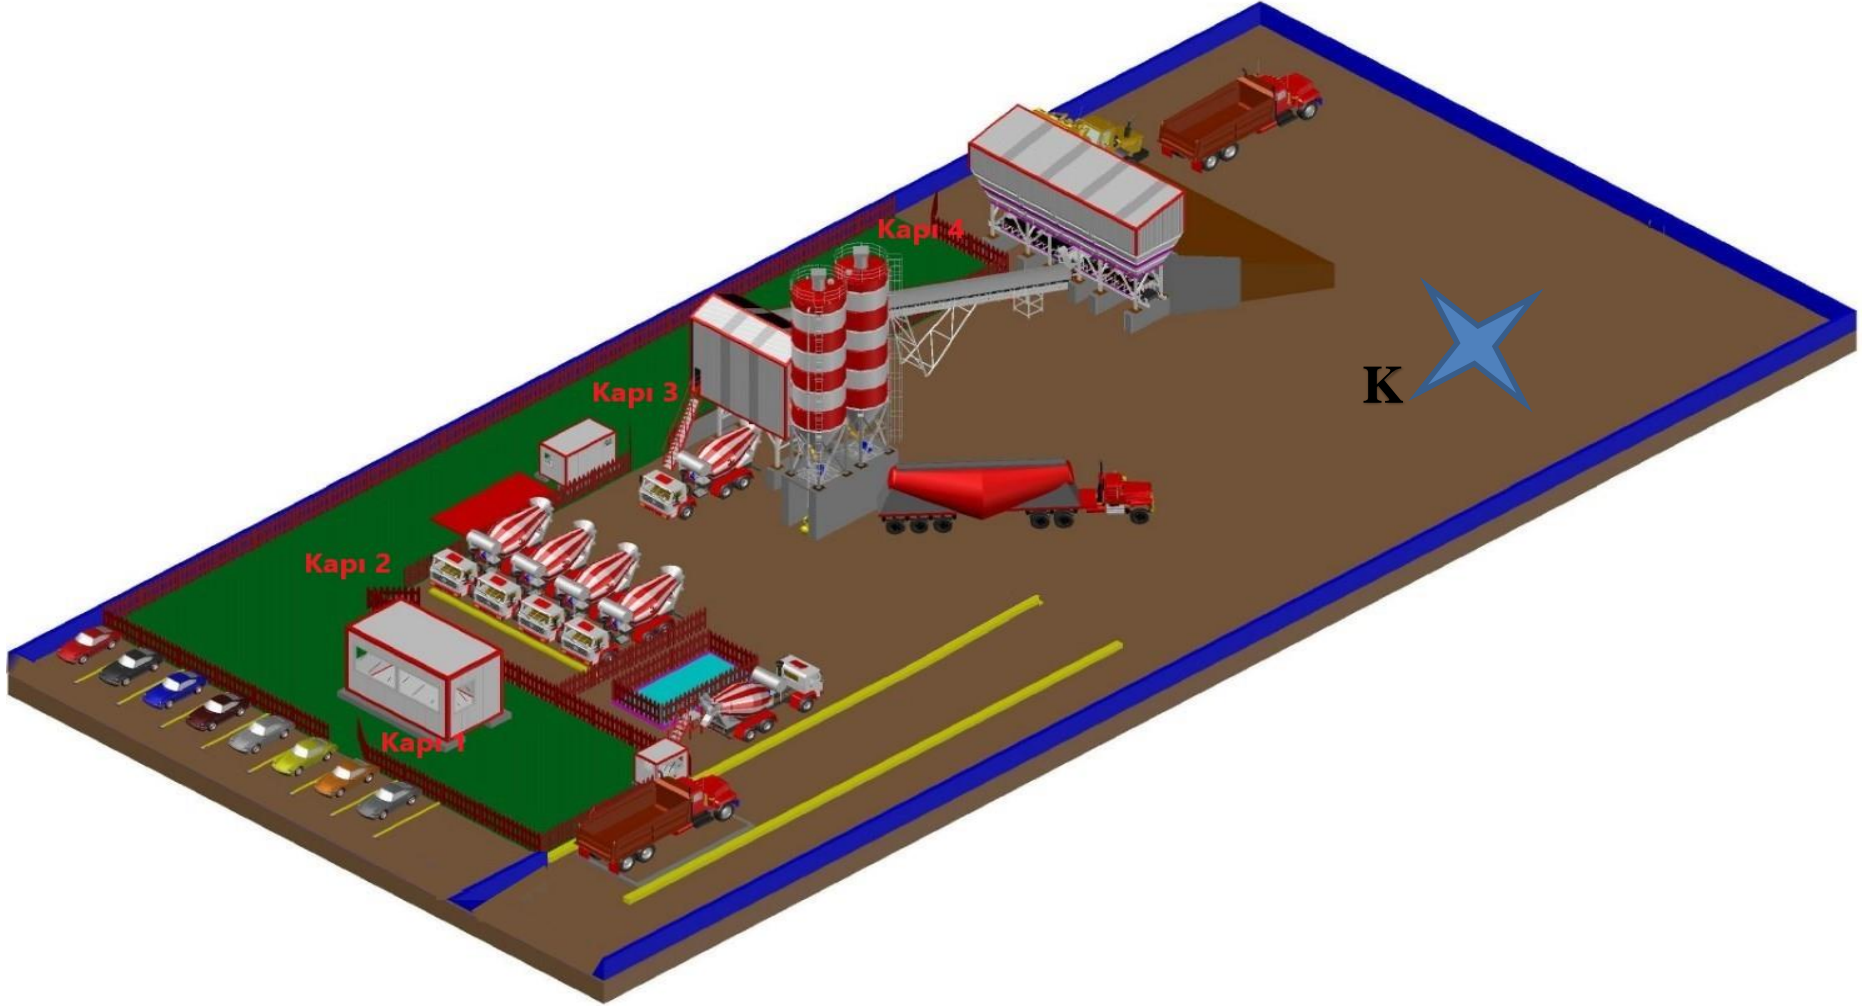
Hazır beton tesisi araç ve yaya trafiğinin ayrıldığı yerleşim planı görünüş 1.
